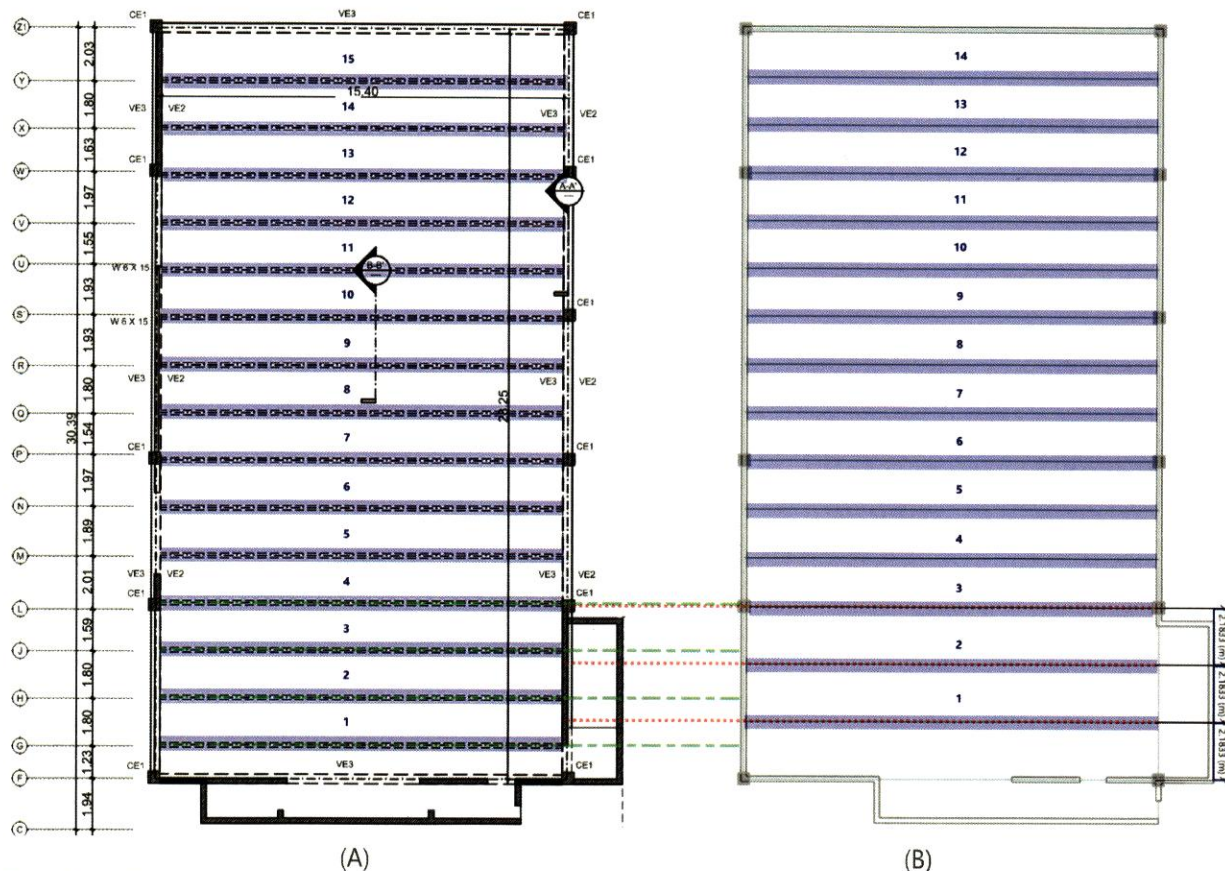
(A) Planta estructural del techo elaborada por ONESVIE, con anotaciones en azul para mostrar las 15 vigas transversales interiores postensadas (imagen de la izquierda), junto a (B) vista en planta del modelo ETABS del gobierno titulado «Modelo Caso Jet Set Club», con anotaciones en azul que muestran solo 14 vigas transversales interiores postensadas (imagen de la derecha). Anotaciones para demostrar la desalineación de las vigas se extienden desde las líneas centrales de las vigas en la planta estructural del techo (línea discontinua verde) y en la vista en planta del Modelo Caso Jet Set Club (línea punteada roja) para una comparación directa. Nótese que se agregaron anotaciones con el espaciamiento de las vigas del modelo ETABS.
